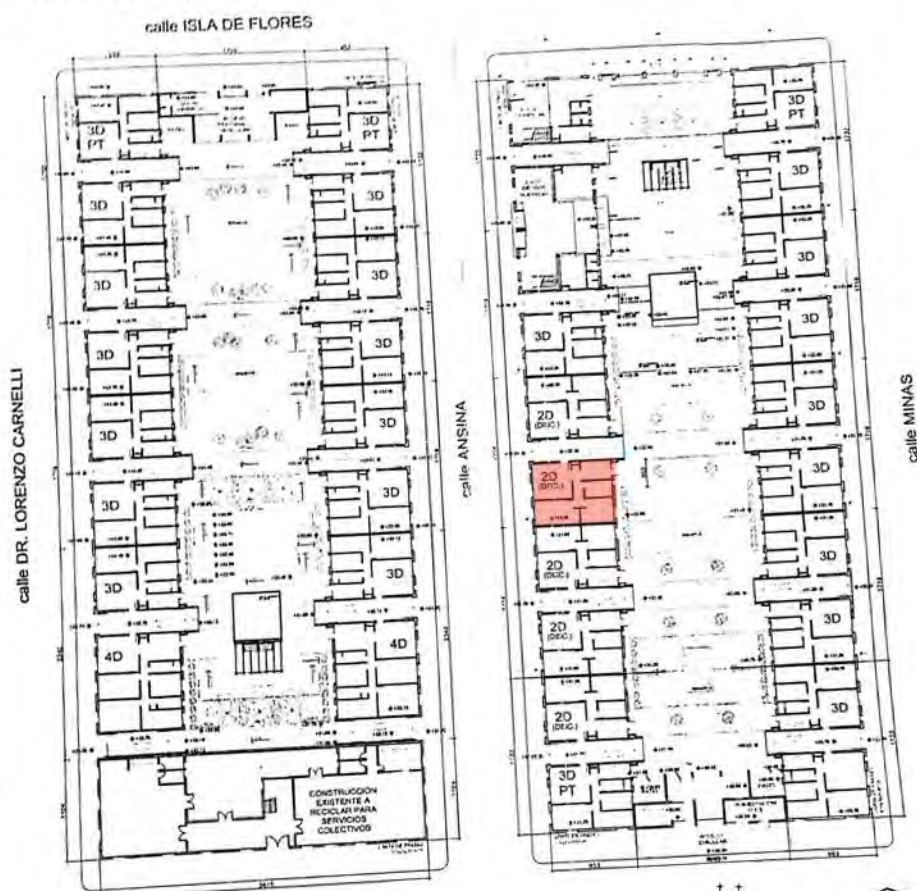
Planta y alzado general de referencia, con la ubicación del apartamento en estudio
